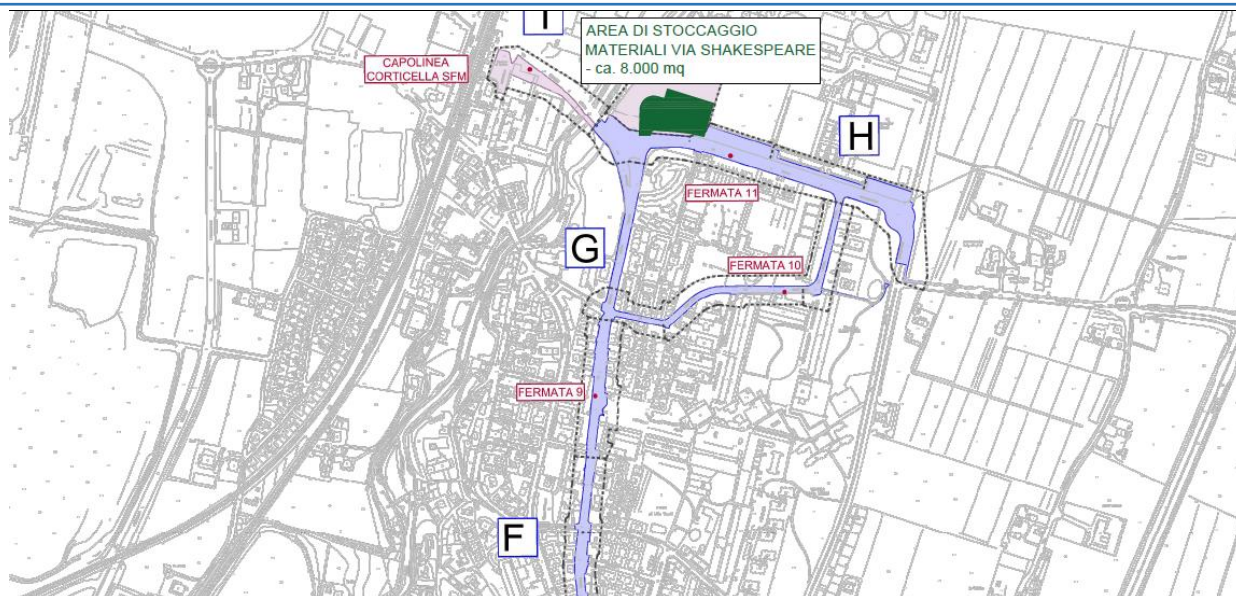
Estratto planimetria "AREE DI STOCCAGGIO"
